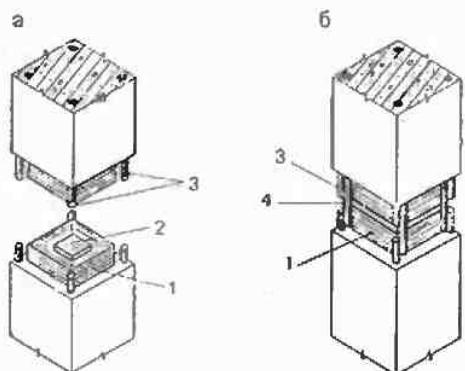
Стыки железобетонных колонн, передающие усилия через металлические элементы
